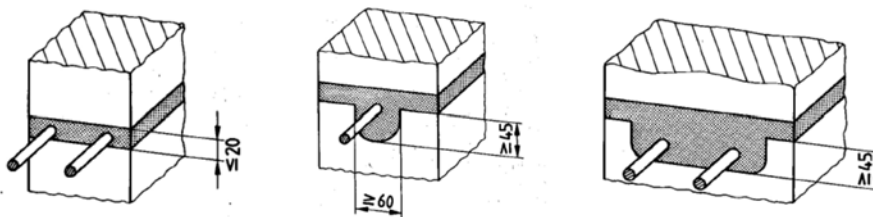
Horizontale Bewehrungsführung nach DIN 1053-3 /X1/
